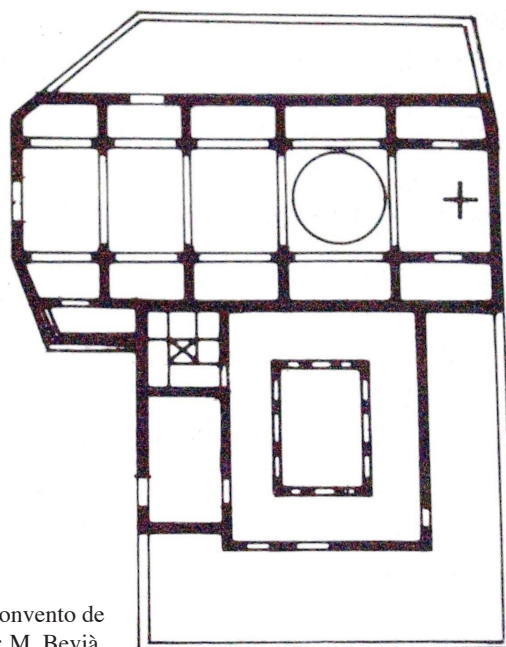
Planta del convento de Carmelitas de Alicante. Autor: M. Bevià.
